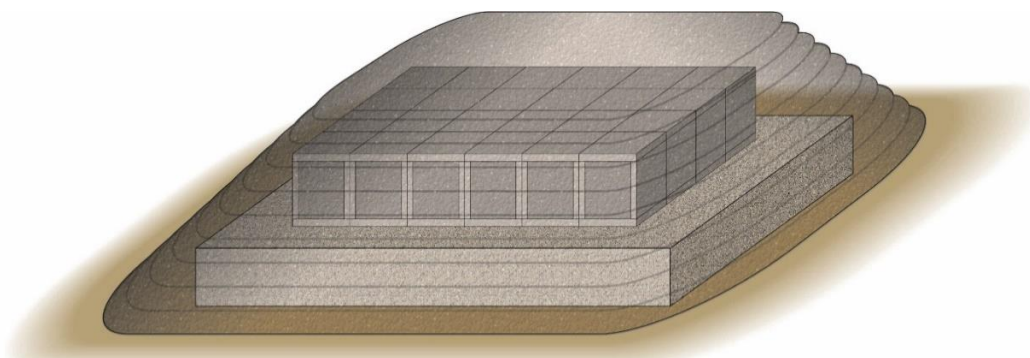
Oberflächennahe Einbettung des Zwischenlagers ins Erdreich
